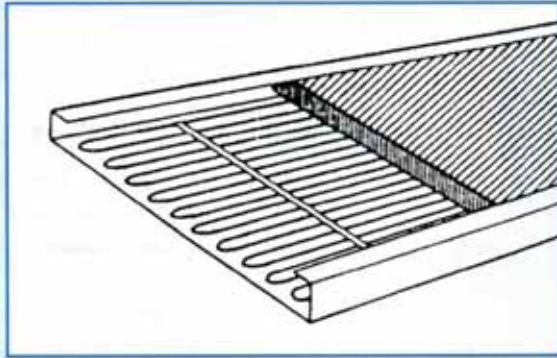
Plafond procédé Ka-ro : nattes de tubes capillaires couchées directement sur la plaque de parement du plafond suspendu.
